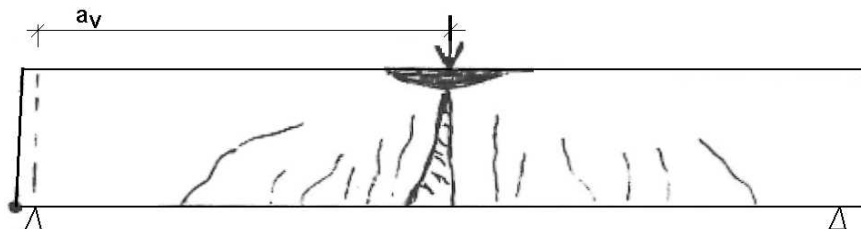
Etat de fissuration à la rupture d'une poutre avec  $a/d$  élevé [10]
